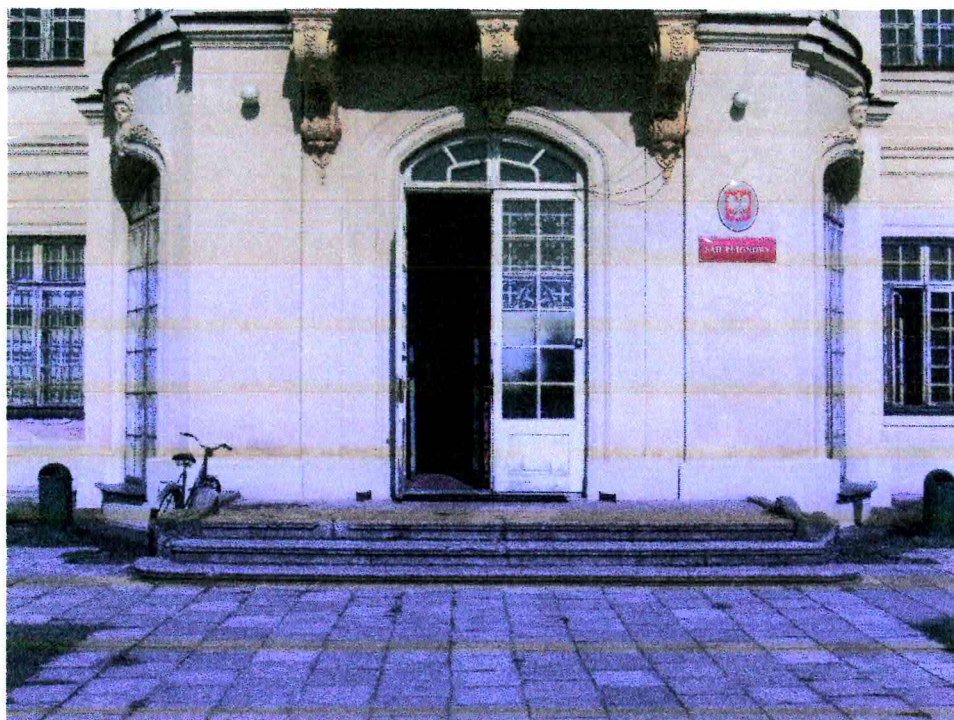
Artykulacja okien w dziedzińcu zachodnim w elewacji wschodniej, widoczne wtórne usytuowanie okien.
